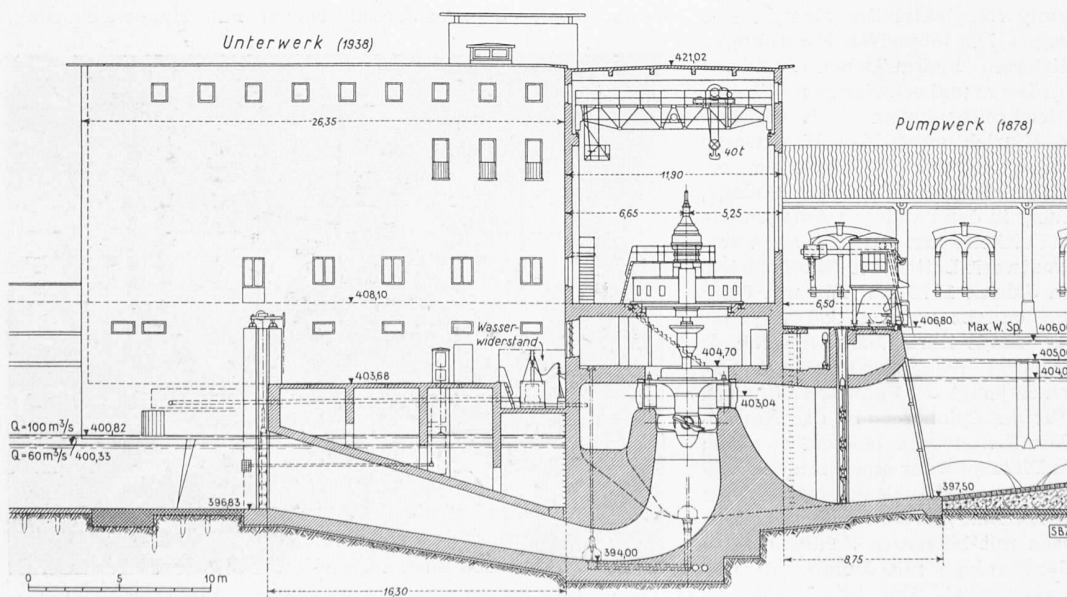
Kraftwerk Letten 1951, Schnitt durch das Maschinenhaus, Masstab 1: 400
